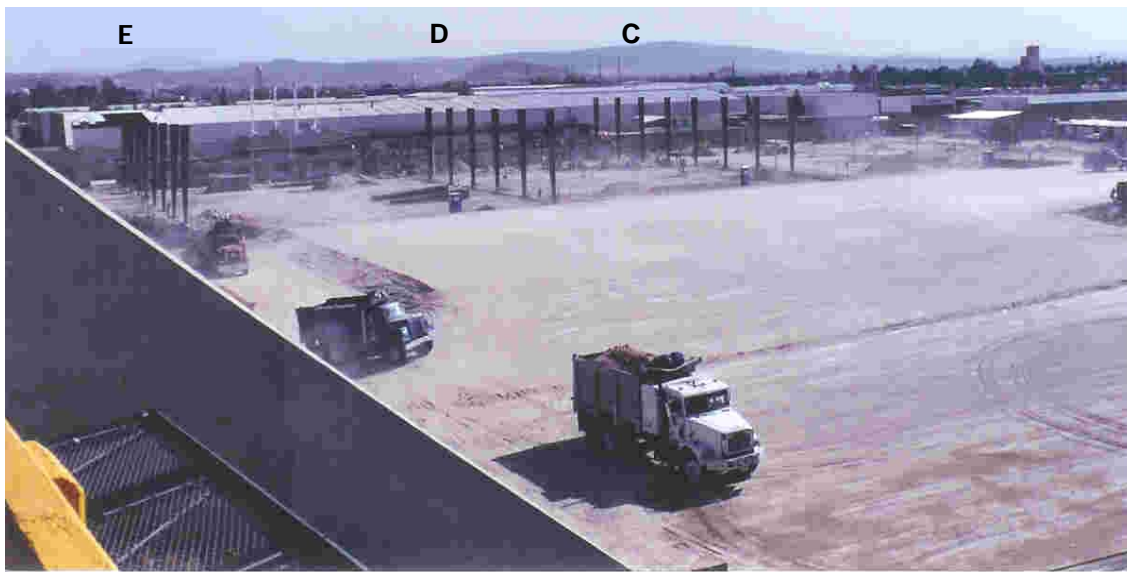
Montaje y plomeado de columnas ejes E, D y C
